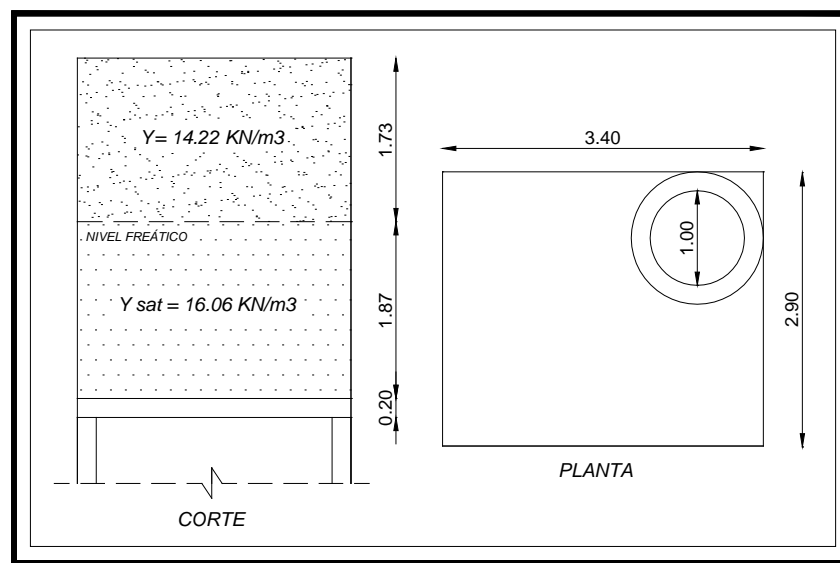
Vista en corte y en planta del Tanque de Almacenamiento
